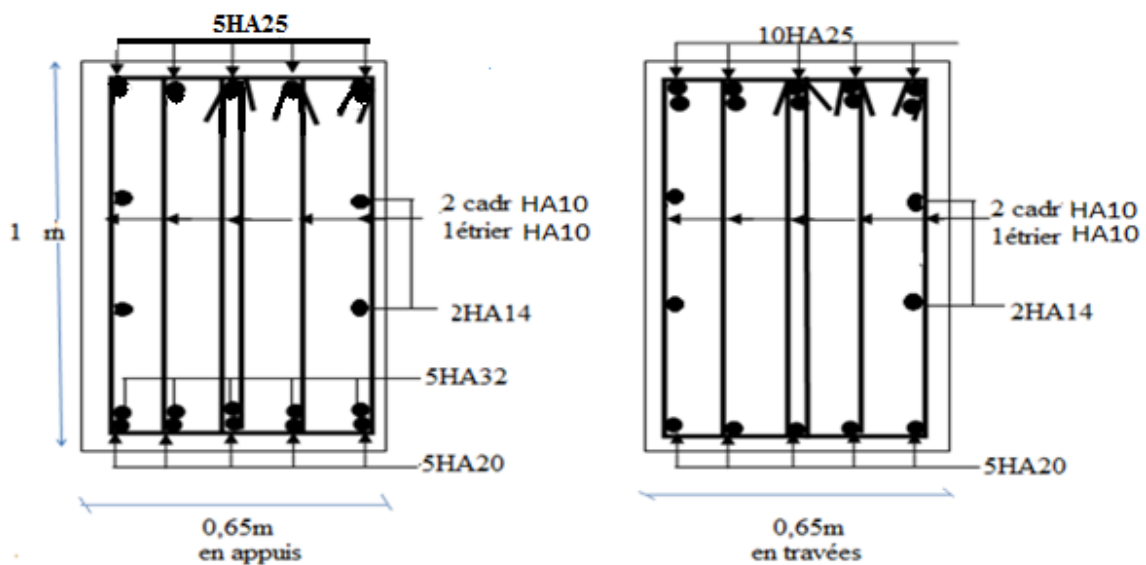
Schéma de ferrailage des nervures dans le sens X-X
